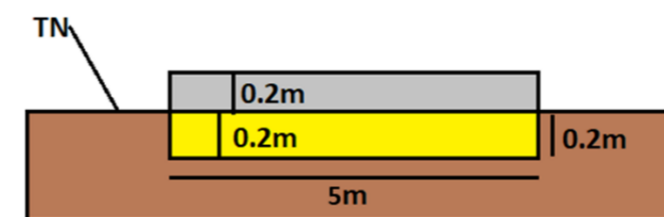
Coupe type d'une piste lourde (source : PHOTOSOL)
